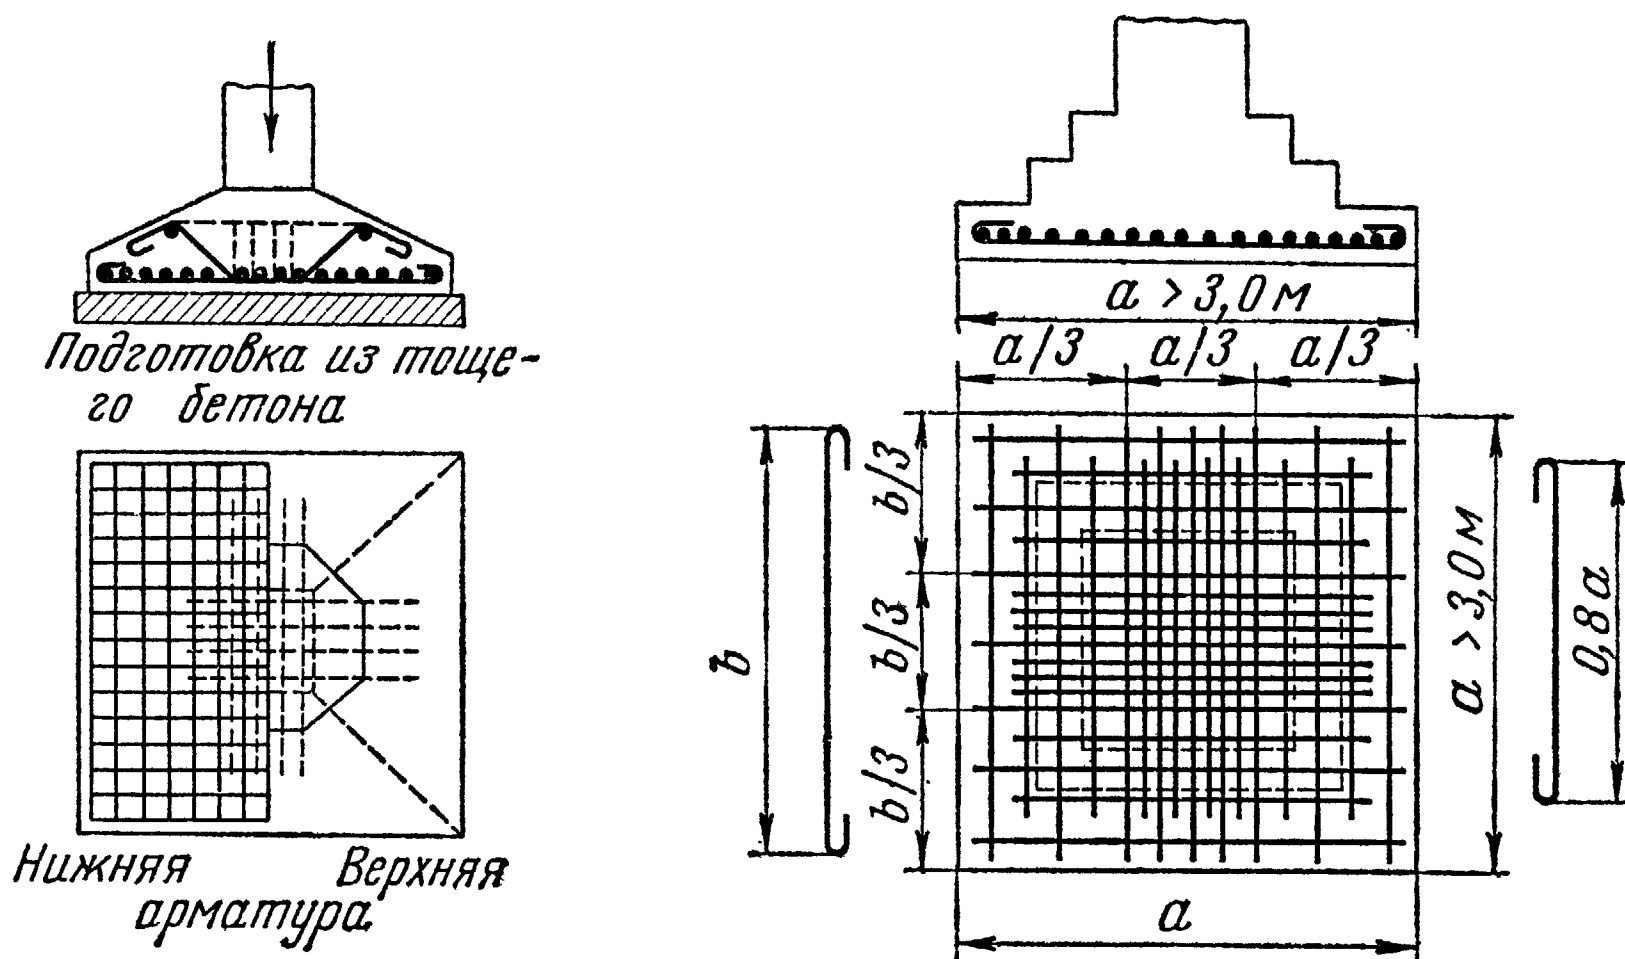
Расположение арматуры в железобетонном столбчатом фундаменте
